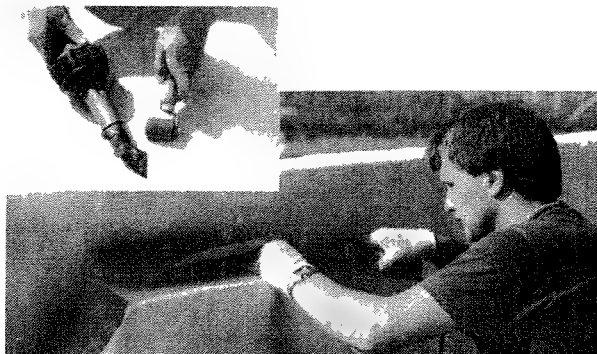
Крепление мембраны ALKORPLAN с помощью ручного сварочного фена
